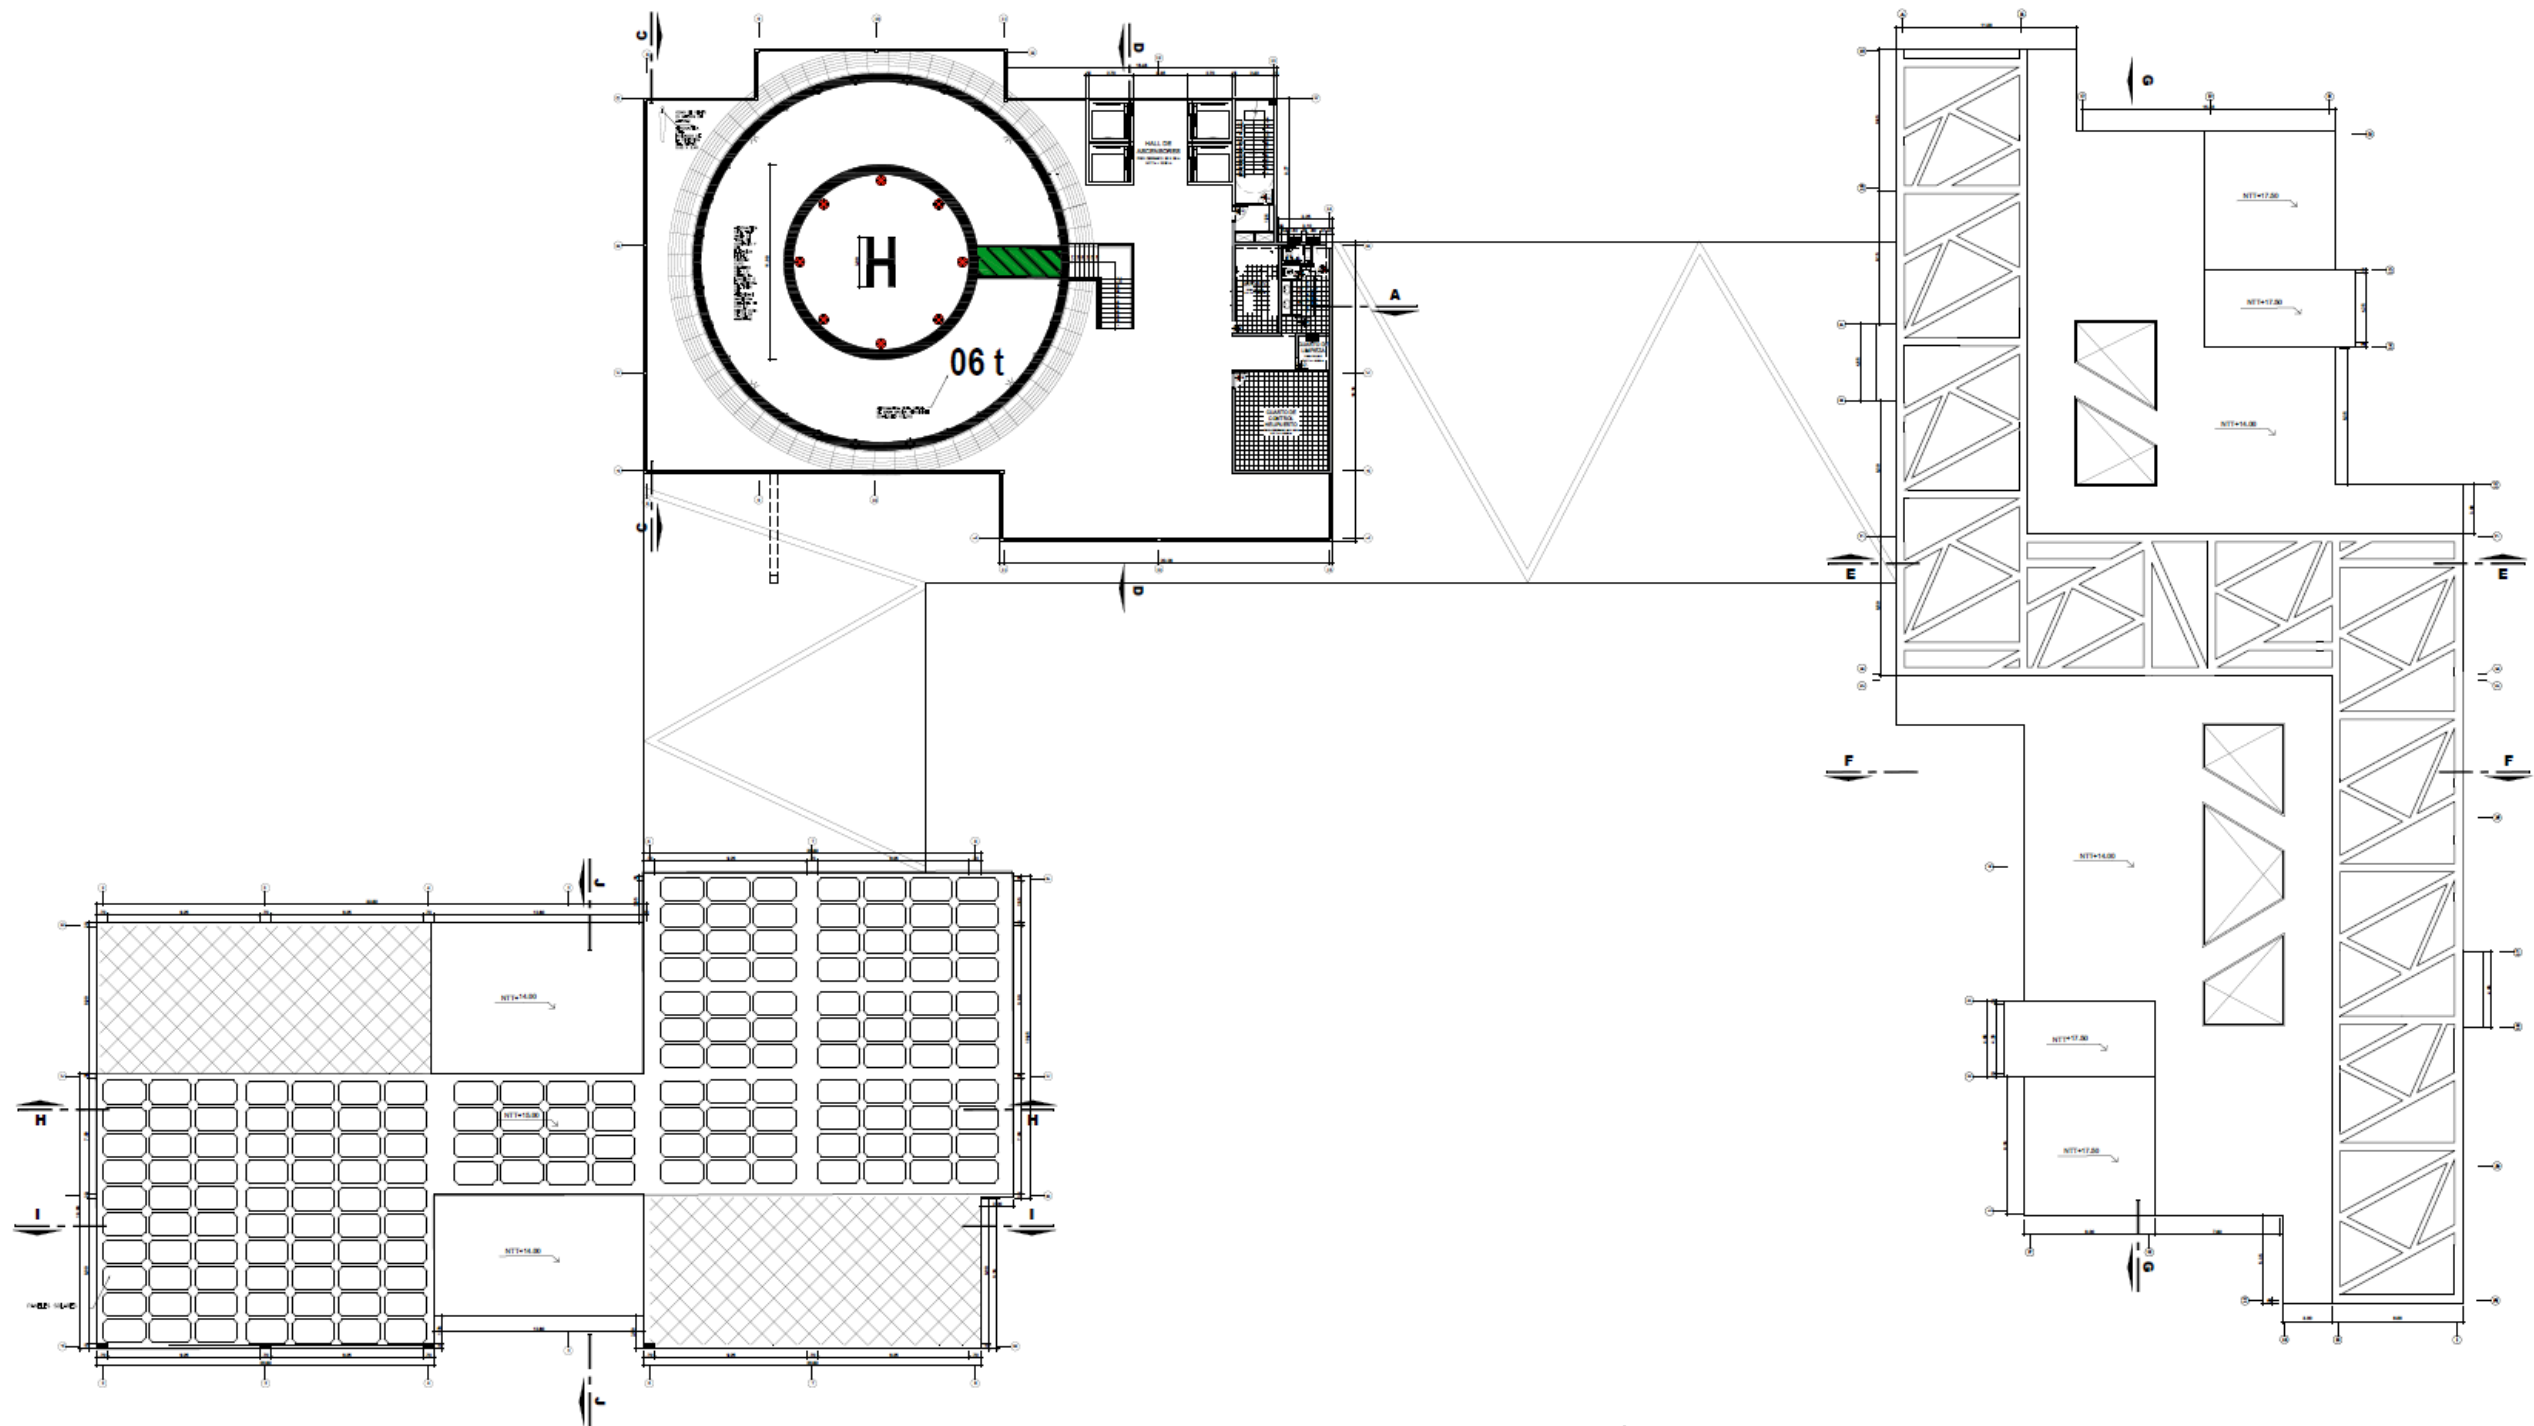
Plano de Techos del Proyecto. Elaboración Propia.
